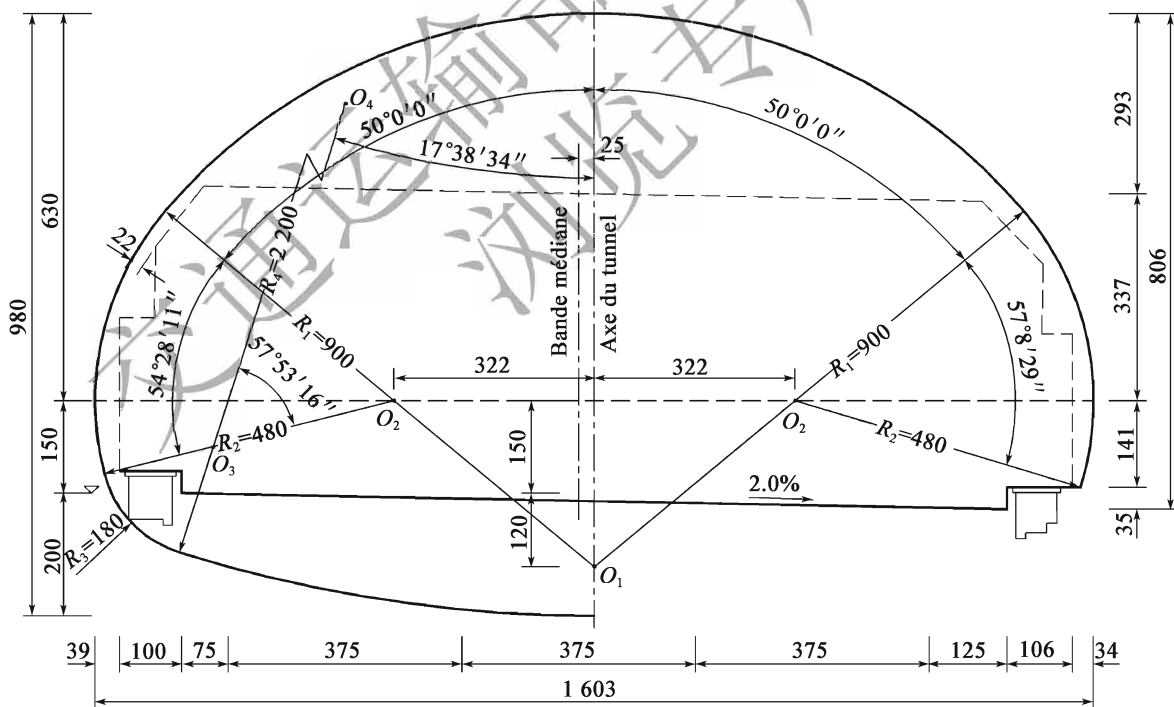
Gabarit du tunnel autoroutier et du tunnel routier de première classe à trois voies(120km/h) (unité ; cm)
